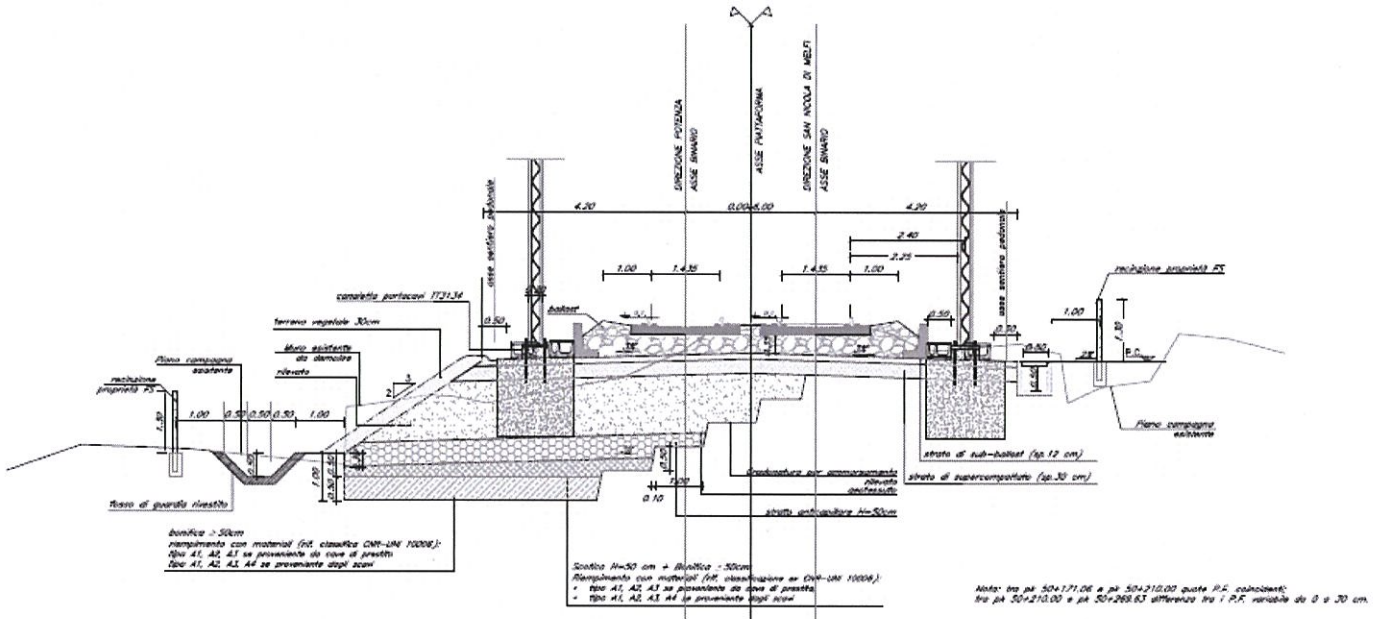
Variante di Rocchetta - Sezione tipo in rilevato in affiancamento
